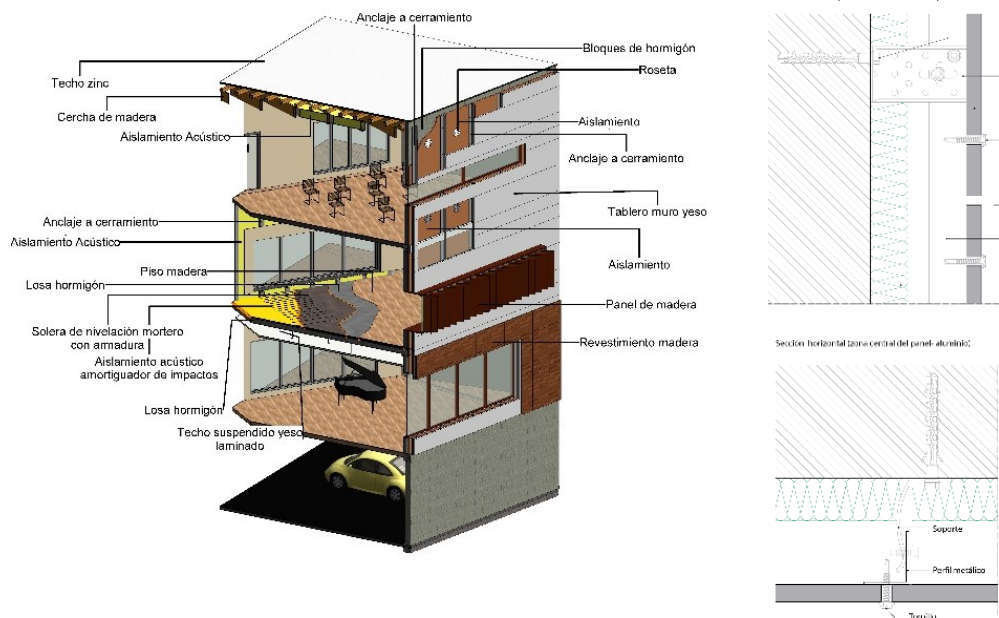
Detalle fachada ventilada, entepiso y cubierta.
